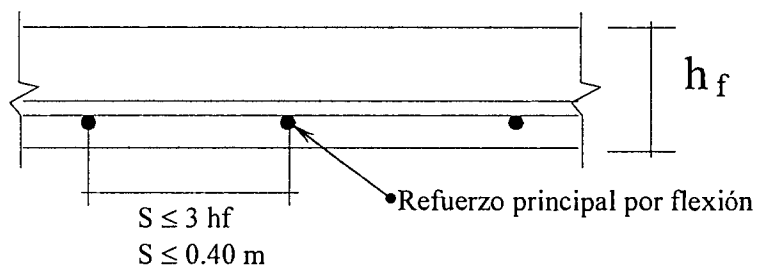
Espaciamiento máximo de las armaduras en losas macizas y muros
